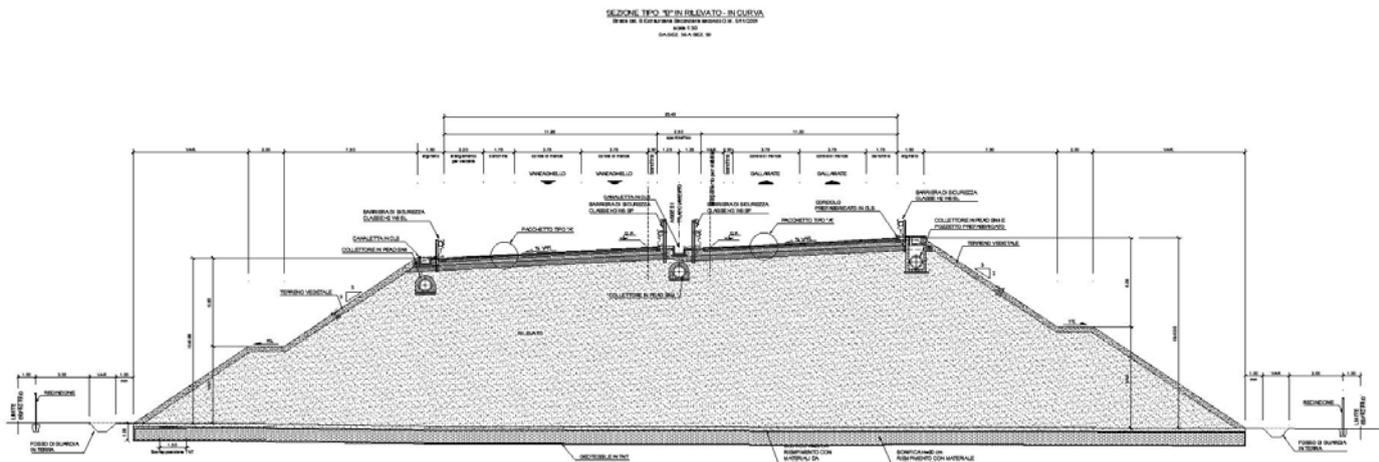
Sezione tipologica Asse Principale cat. B in rilevato
